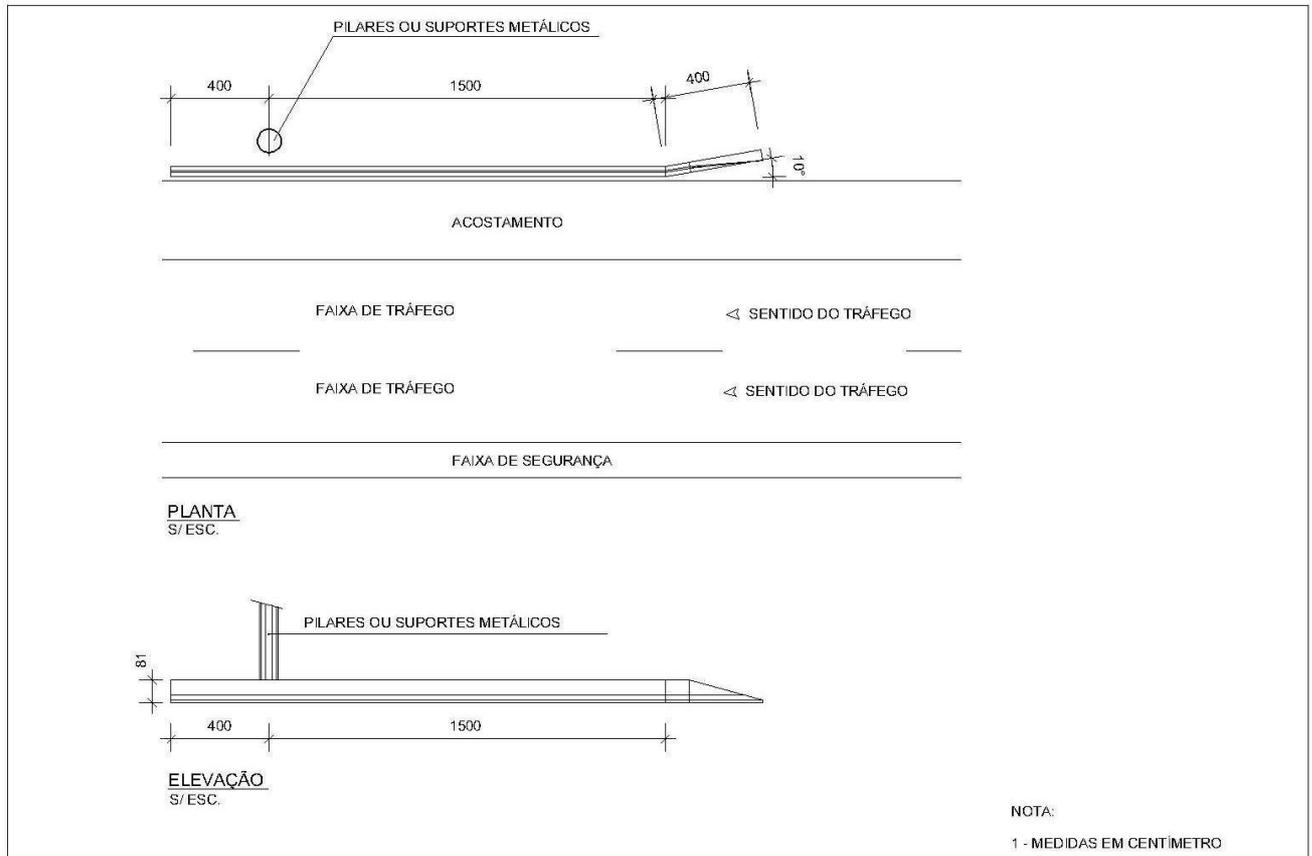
Esquema de Proteção de Pilar de Passarela com Barreira Rígida em Pista Simples
